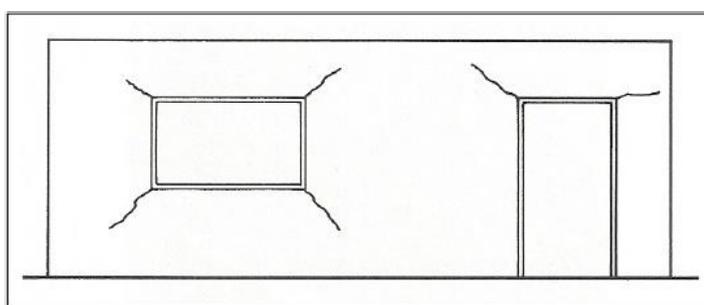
Fissuração típica nos cantos das aberturas, sob atuação de carga
